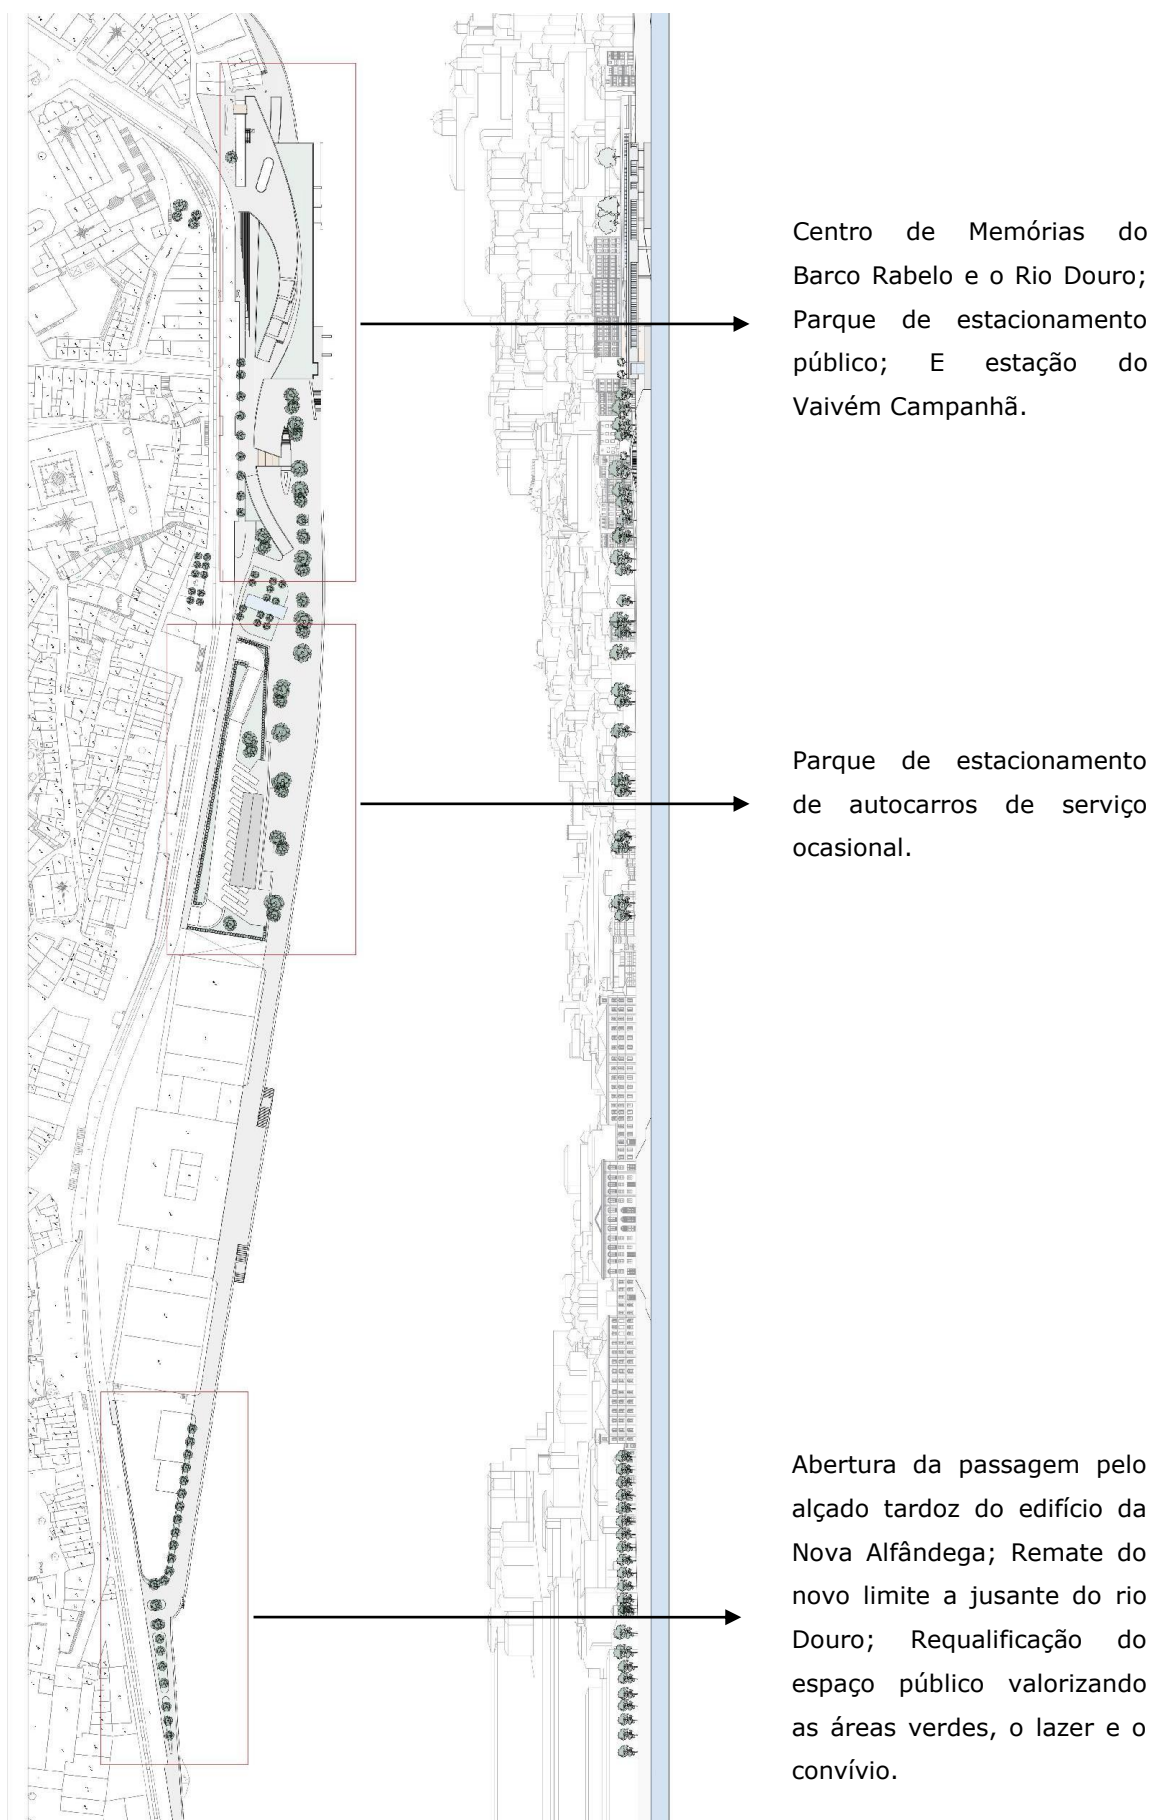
Planta e perfil da implantação da proposta (Sem escala).
